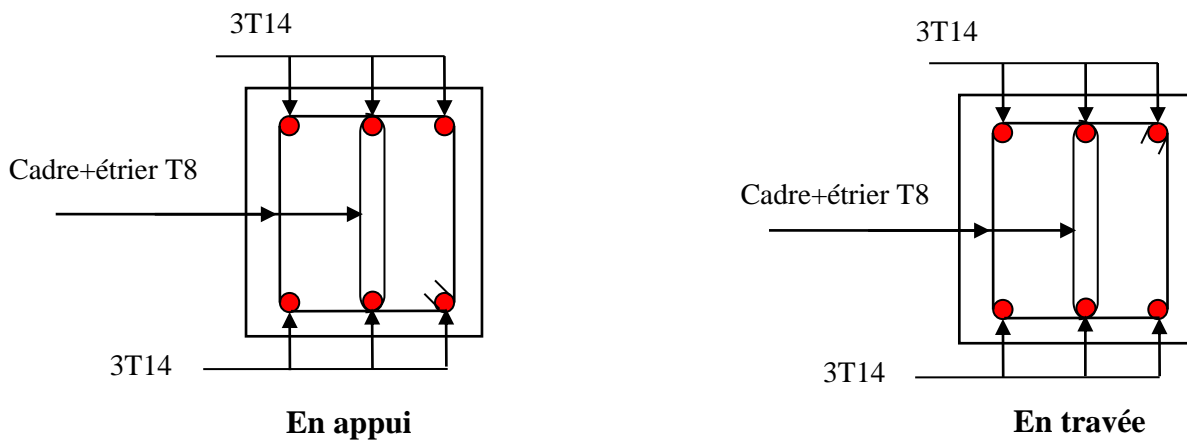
Schémas de ferrailage des poutres secondaires sous sol
